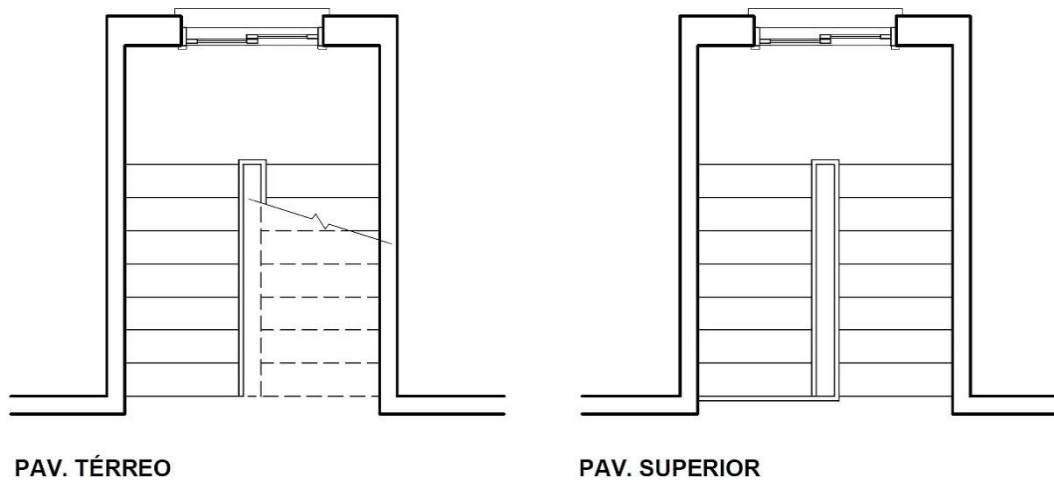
3º passo na representação de uma escada em planta baixa. Fonte: autor
